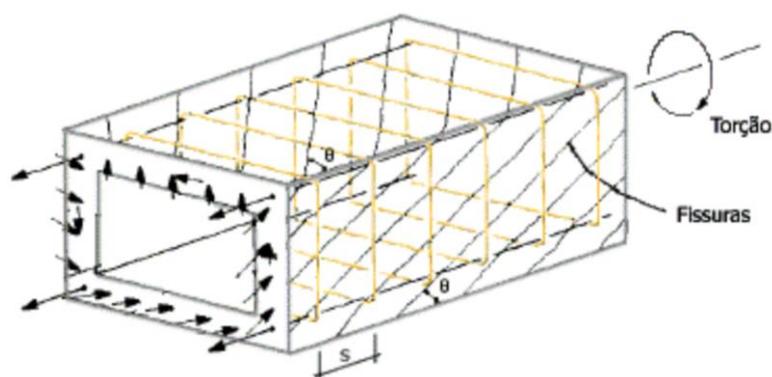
Representação esquemática da fissuração devido ao esforço de torção diagonal.
